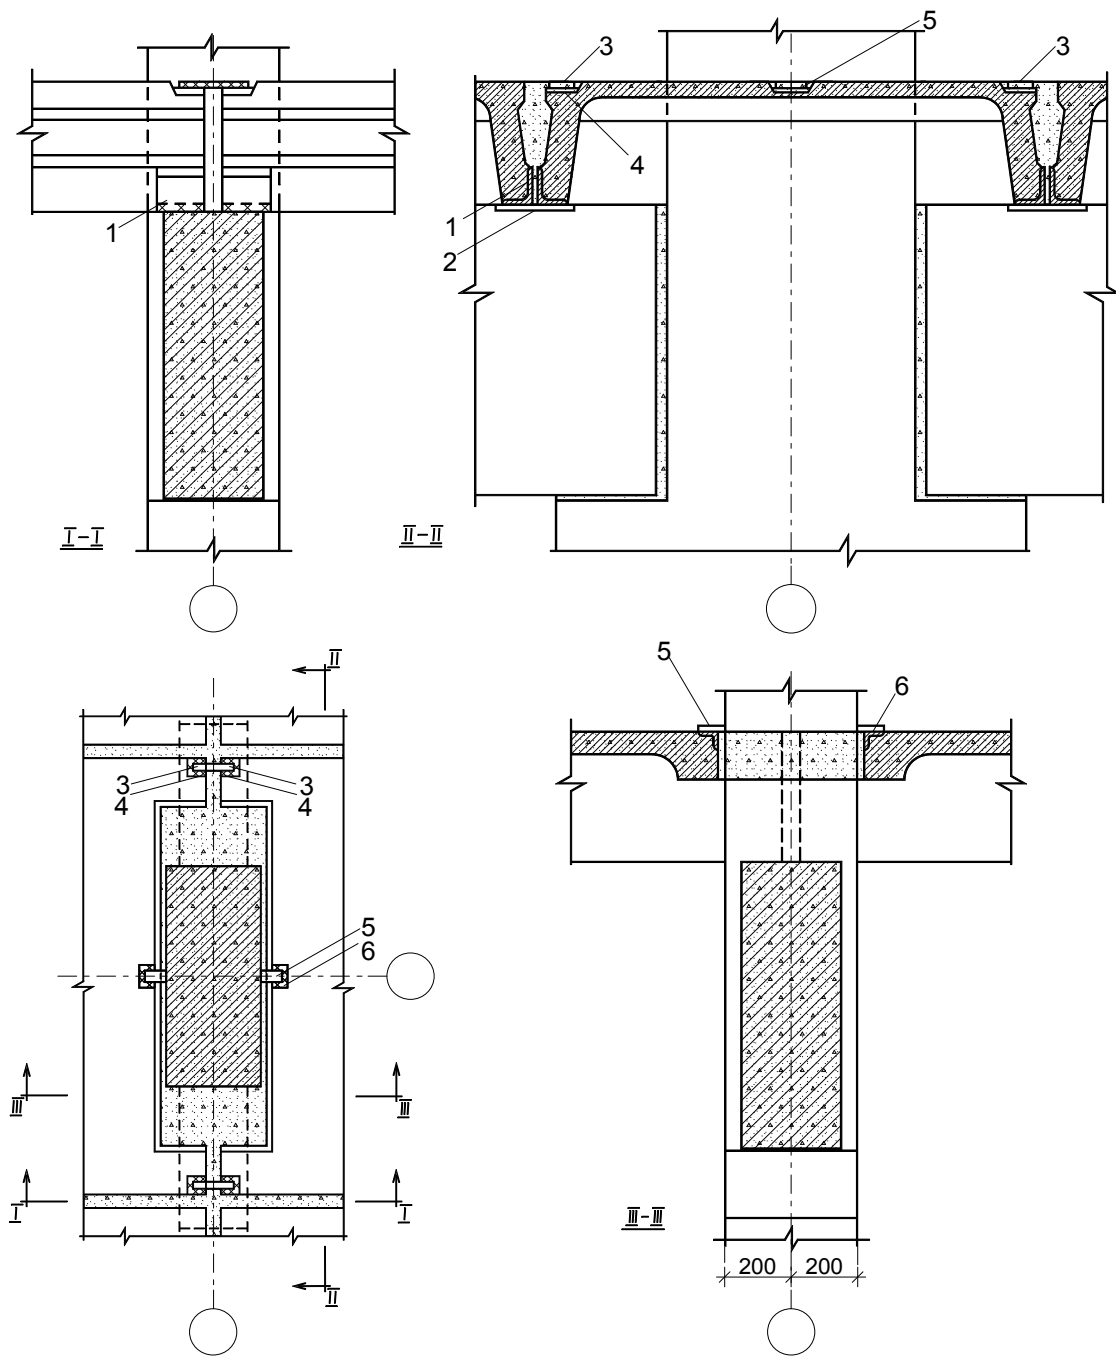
Деталі кріплення плит перекриття біля середньої колони при ригелях прямокутного перерізу: 1 – нижні закладні деталі плит; 2 – закладна деталь ригеля; 3 – накладки зі смужової сталі; 4 – верхня закладна деталь плити; 5 – коротиші прокатного кутика, приварені в розпір з колоною; 6 – верхні і середні закладні деталі плити
